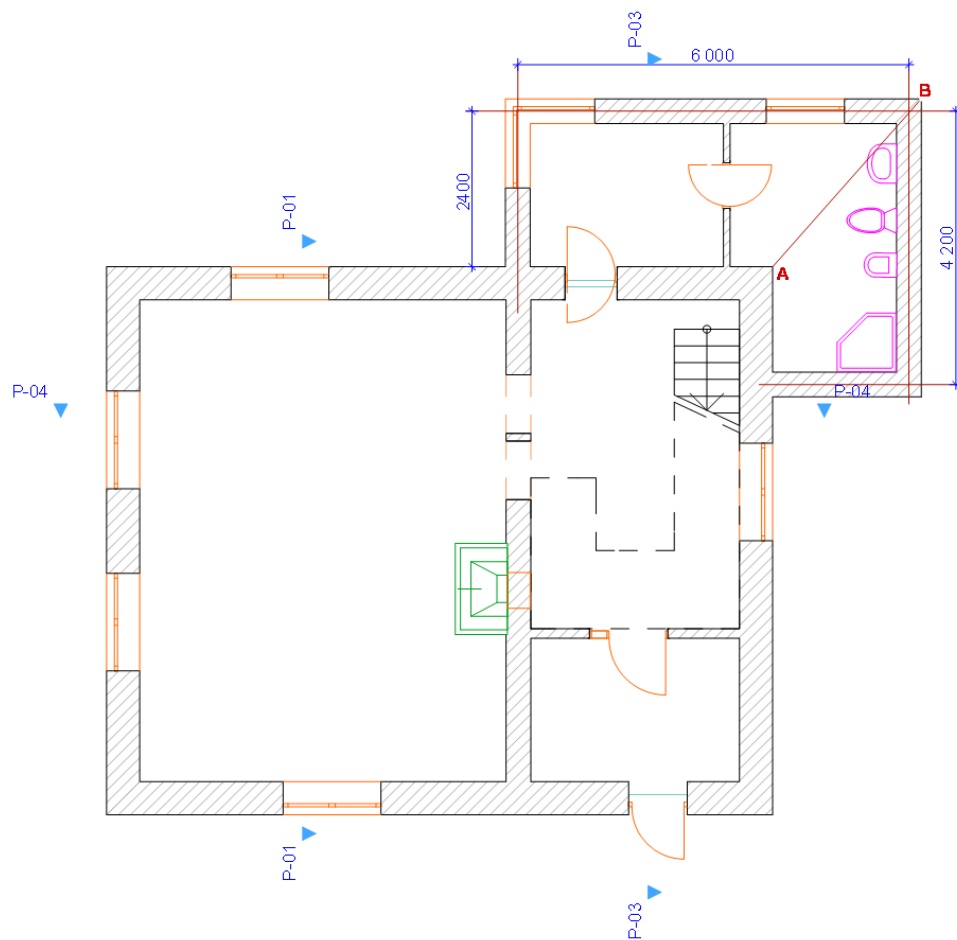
Размеры и планировка хозяйственной пристройки.
